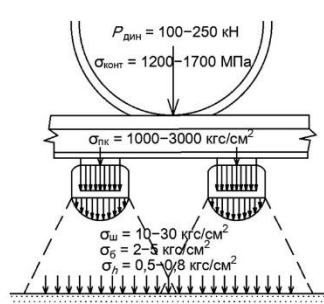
Схема передачи вертикальной нагрузки колеса на земляное полотно
